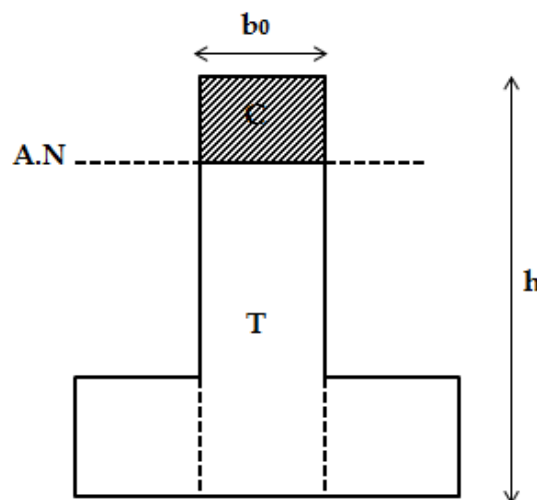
La section de la poutrelle en appui sollicité à la F.S
